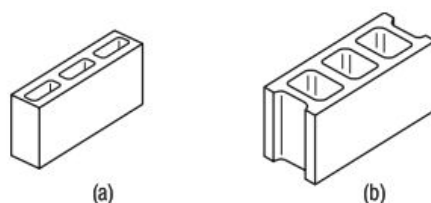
Elementos de mampostería de hormigón: (a) de no carga y (b) de carga.
